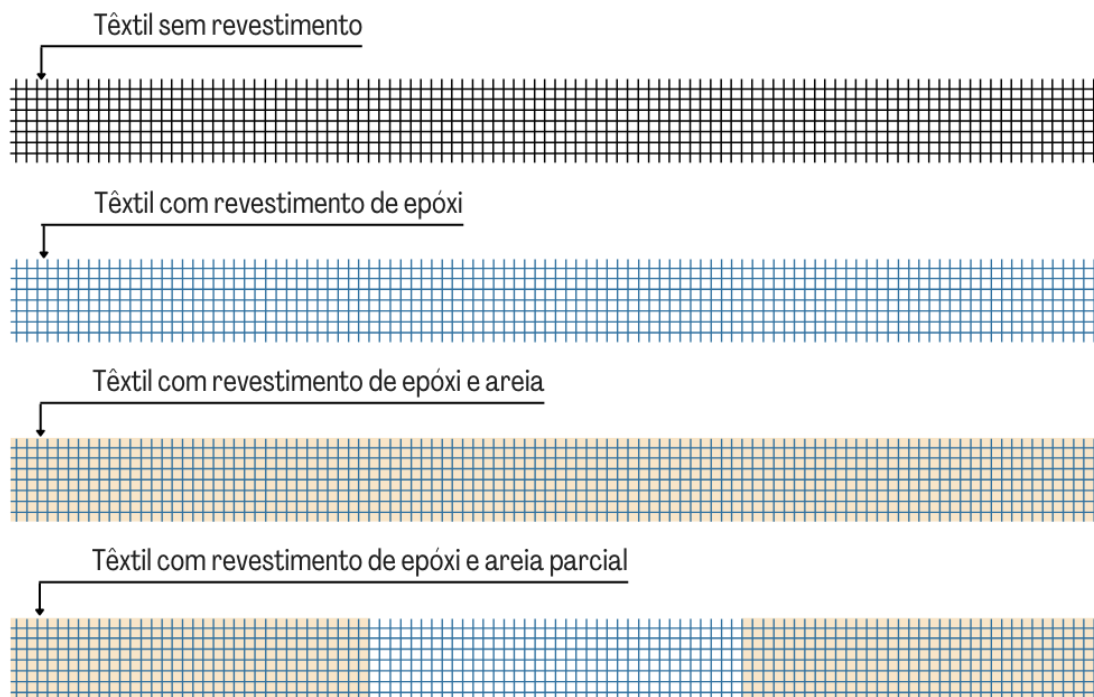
Configurações de revestimento para o têxtil (Fonte: Autor)
